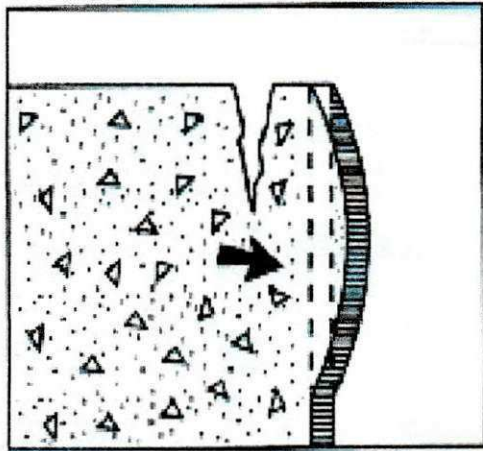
Fissura causada por movimentação da fôrma
